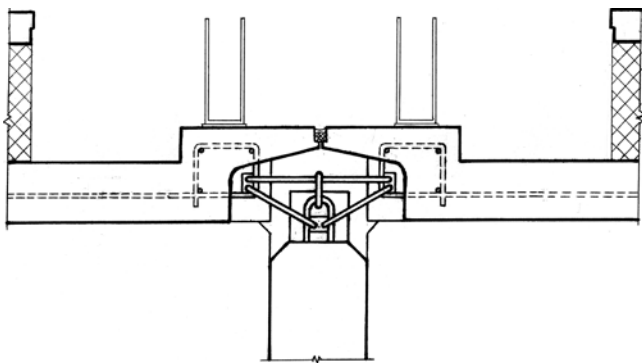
Участки наружных панелей у боковых торцов до монтажа навесного фасада [3]
